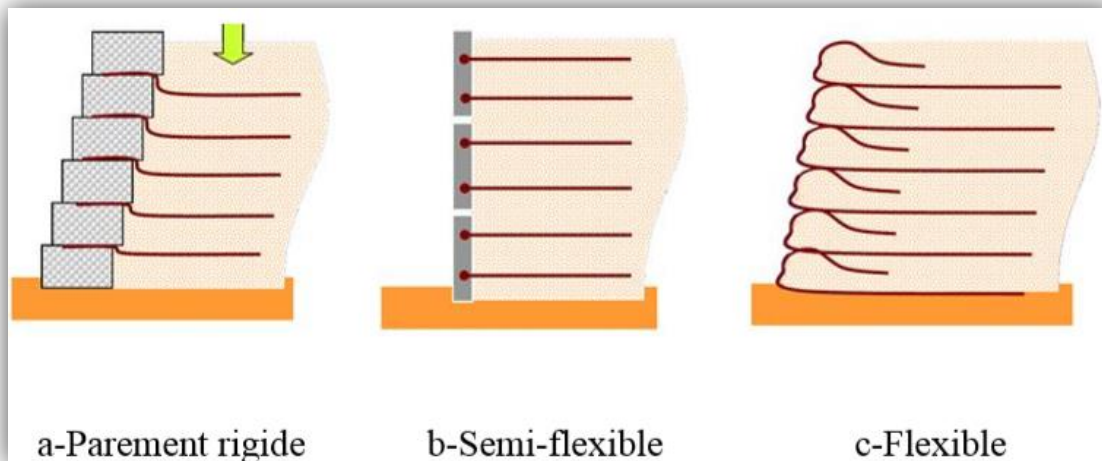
Système de parement (d'après Pierre SEGRESTIN, 2009)
